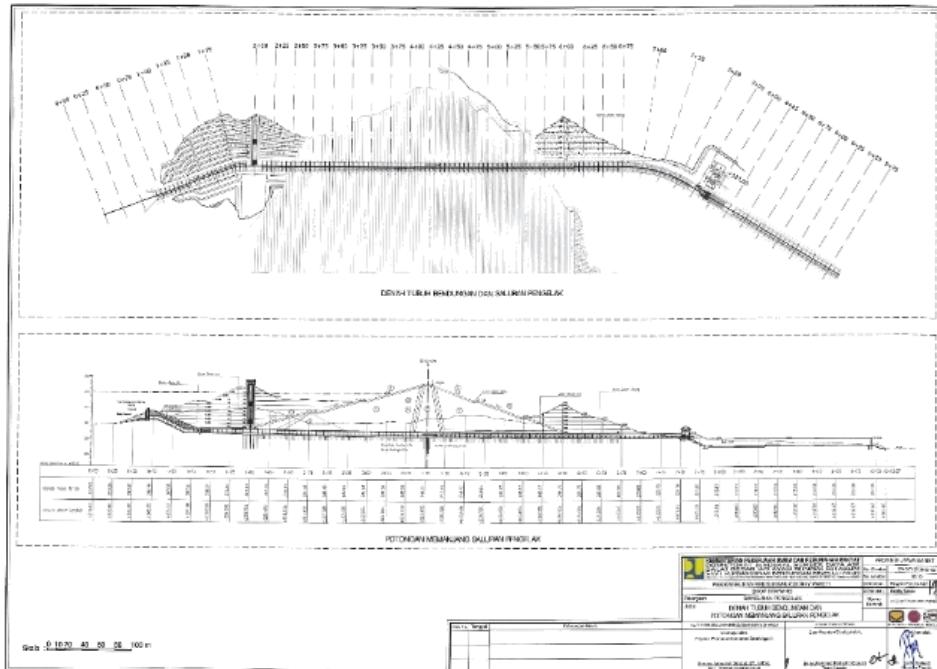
Layout Saluran Kondukti Bendungan Cijurey
